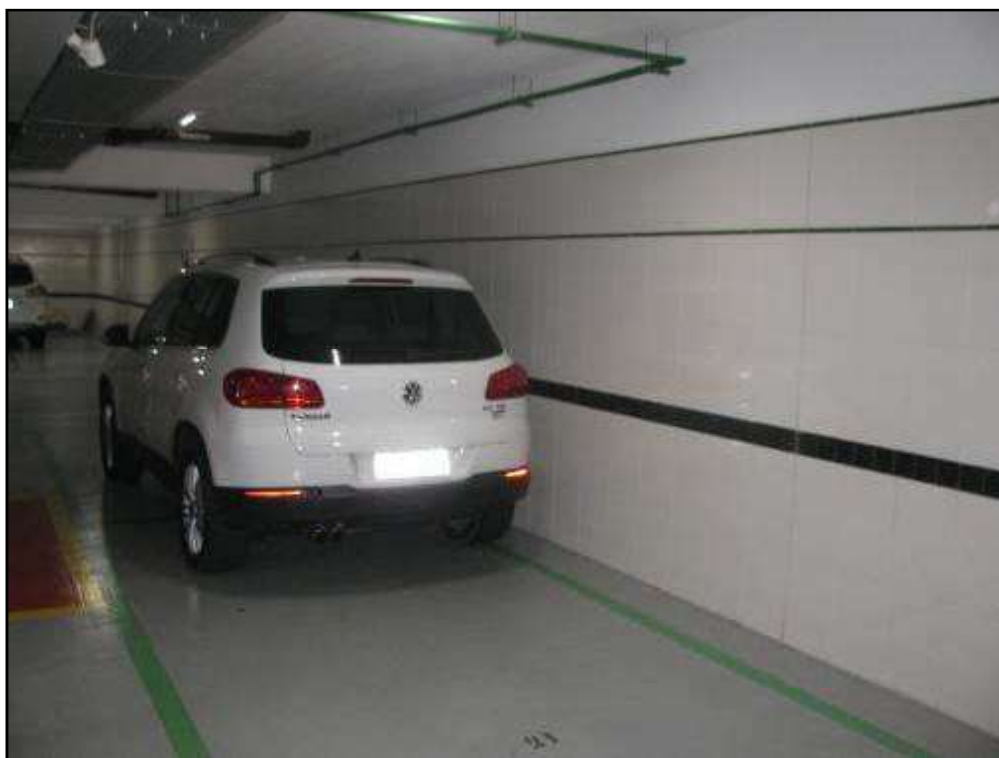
VISTA DA VAGAS DO APARTAMENTO 21.
